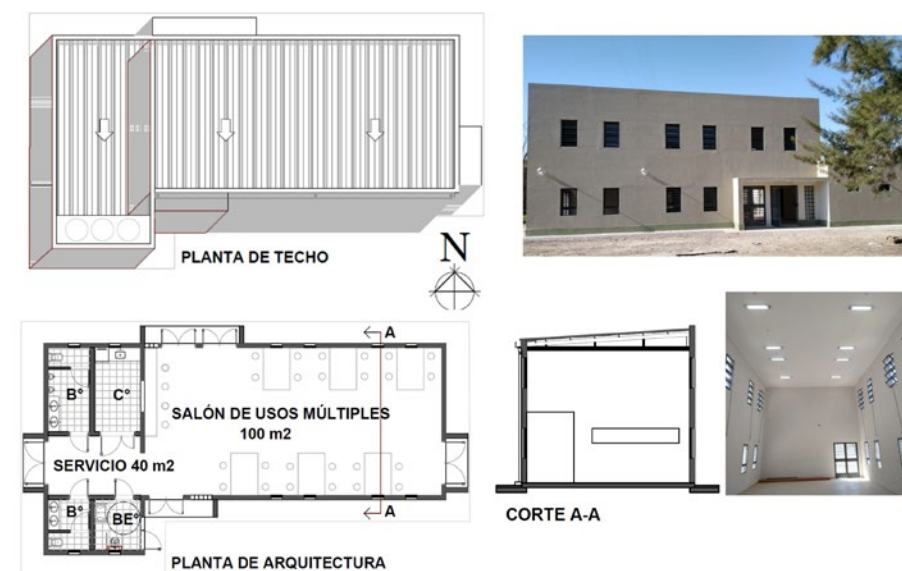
| Planimetría de SUME y fotografías de vistas exterior e interior. Fuente: elaboración propia y fotografías tomadas por el equipo de trabajo.
